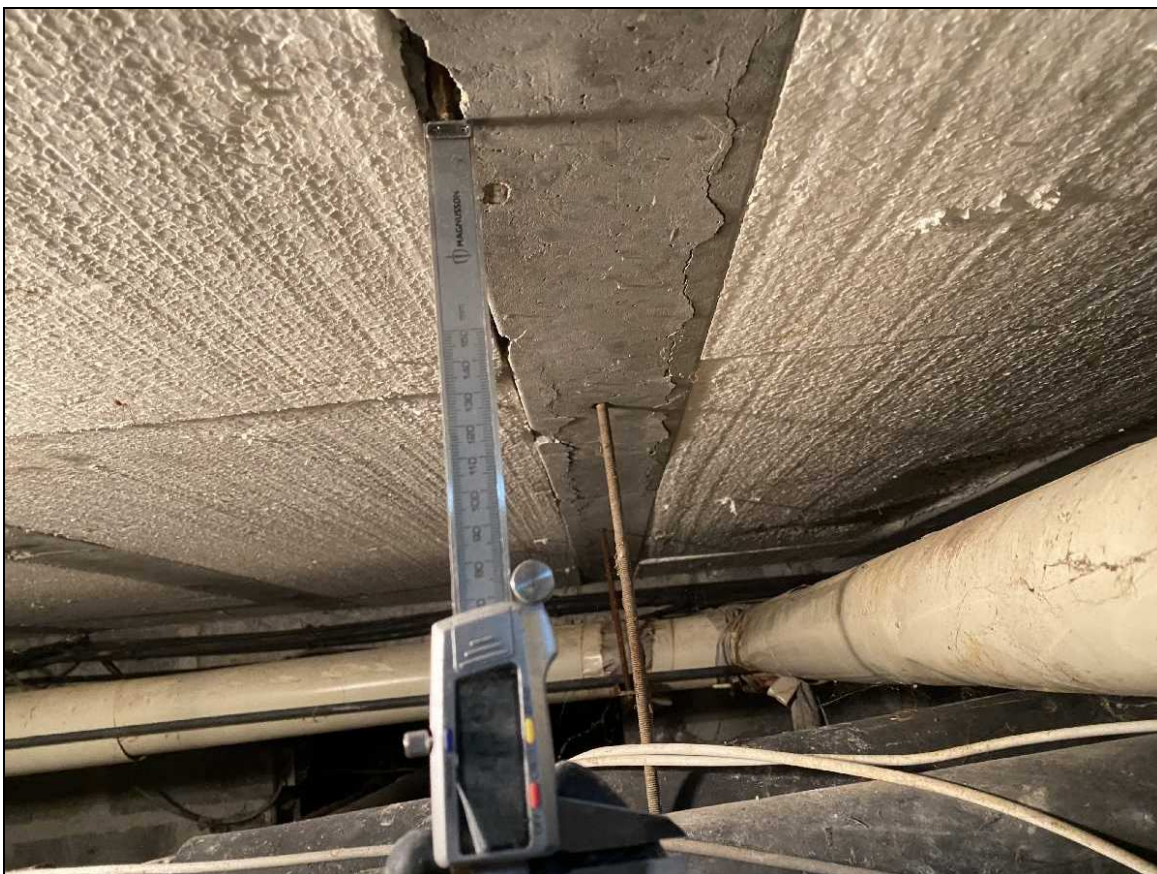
Enrobage très faible des crochets de levage (< 5 mm)
